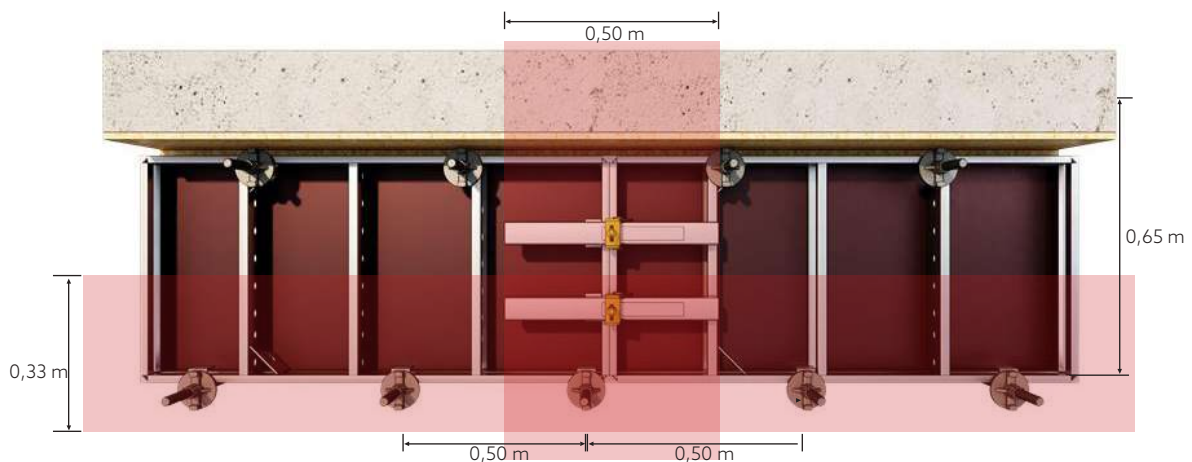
Área de influência nas barras de ancoragem - Vista lateral viga
